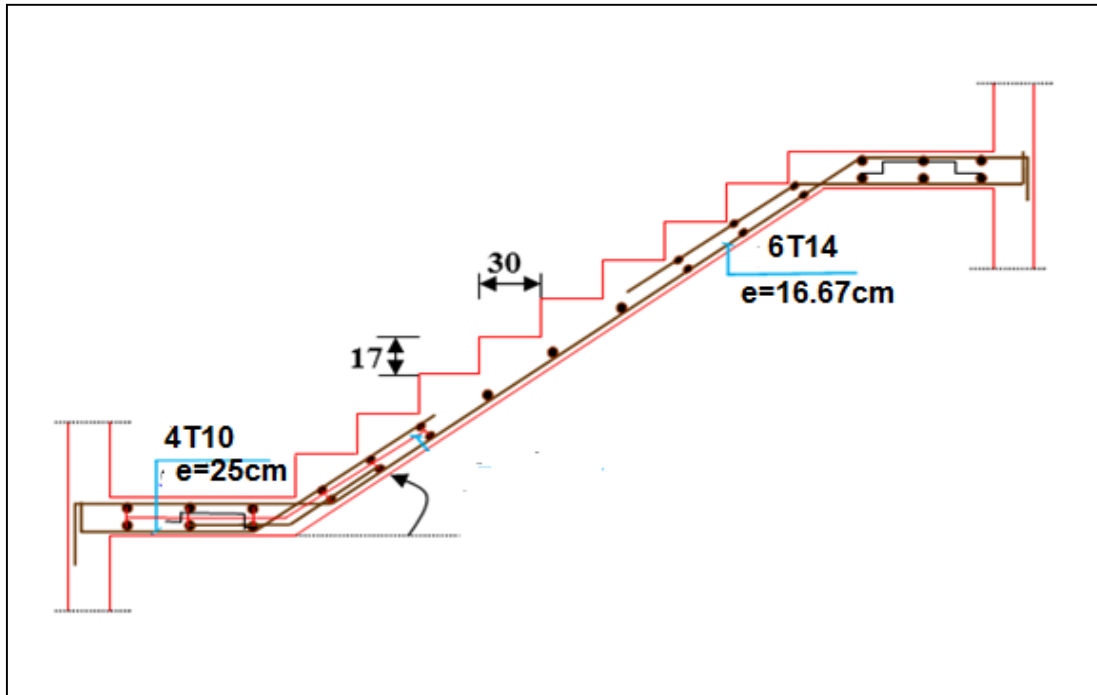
Schéma de ferrailage de l'escalier type 02.
